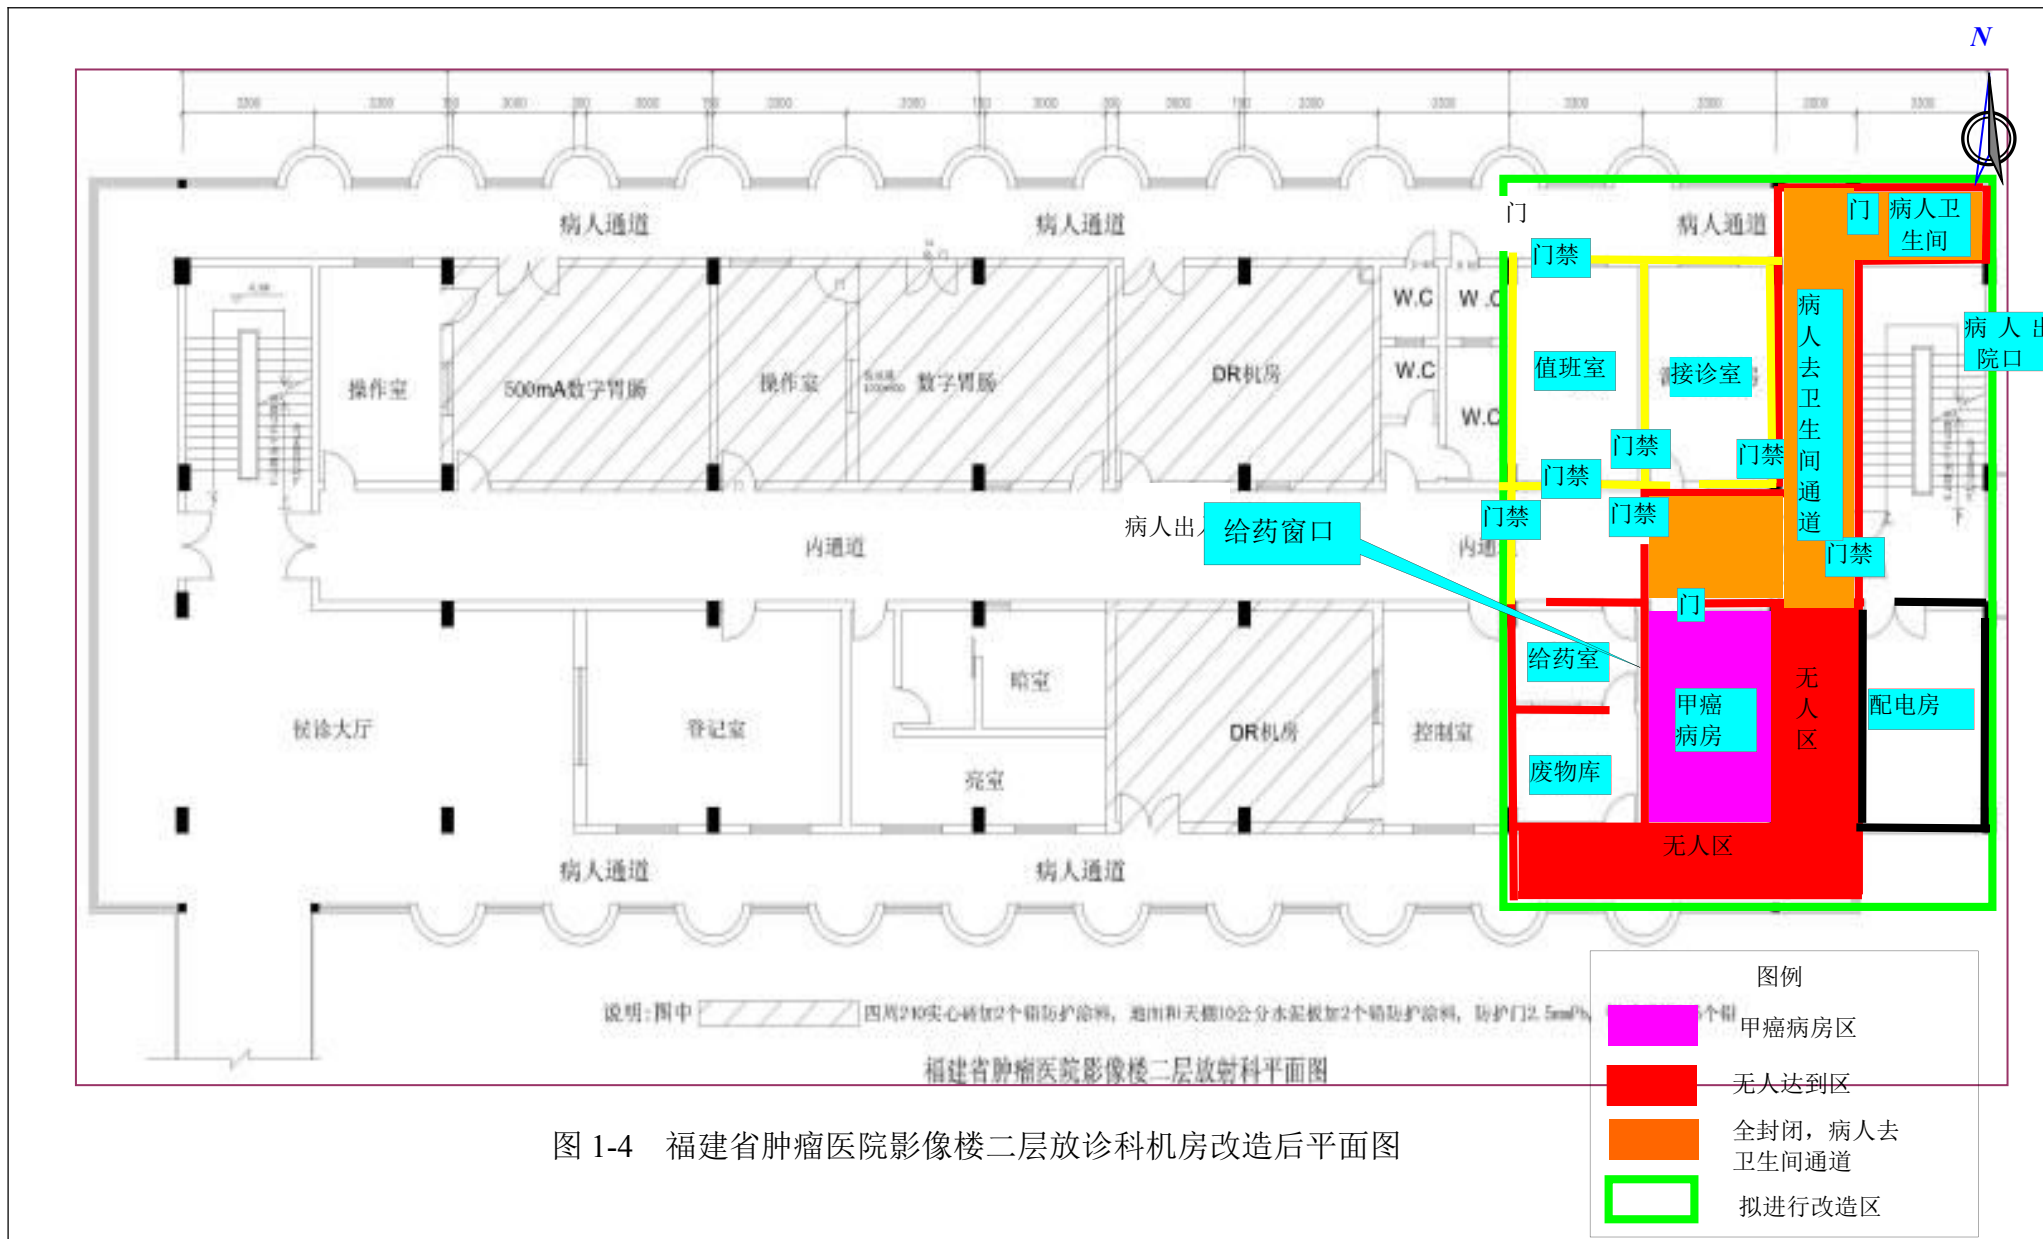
福建省肿瘤医院影像楼二层放诊科机房改造后平面图
